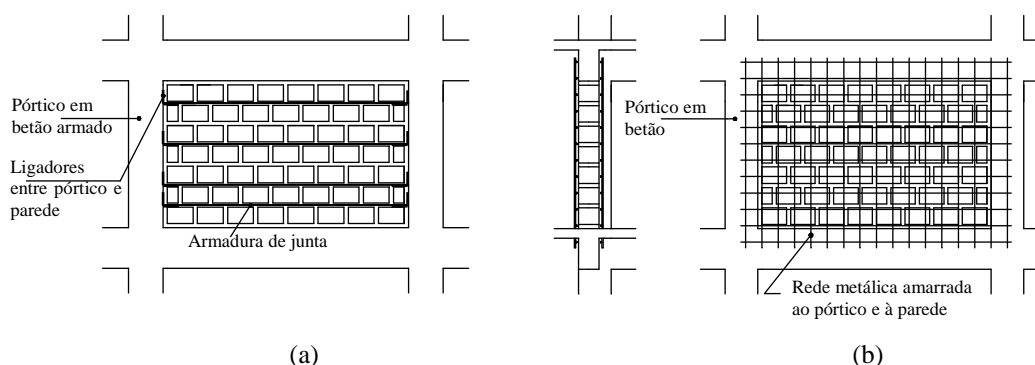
Soluções para controlo de danos em paredes de enchimento sem aberturas: (a) alvenaria com armadura de junta e ligadores; (b) rede metálica ancorada à parede.
